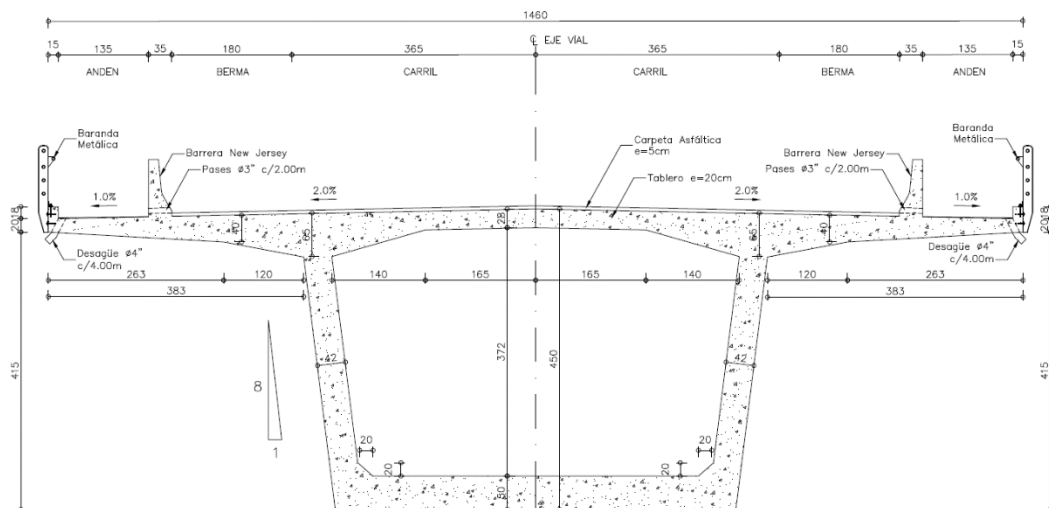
Sección transversal de la superestructura del puente San Pedro.
